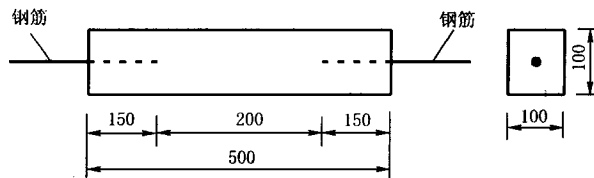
混凝土抗拉强度试验试件(尺寸单位:mm)
